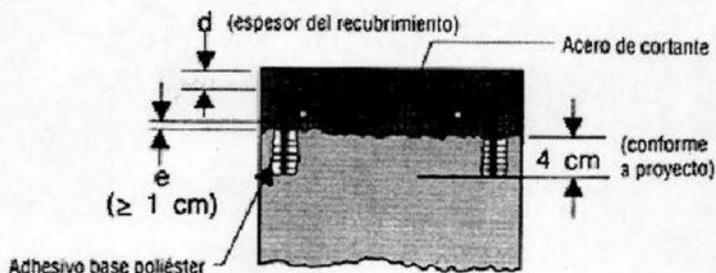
Refuerzos – Enmiendas para reconstruir la sección de acero de refuerzo, por traslape
